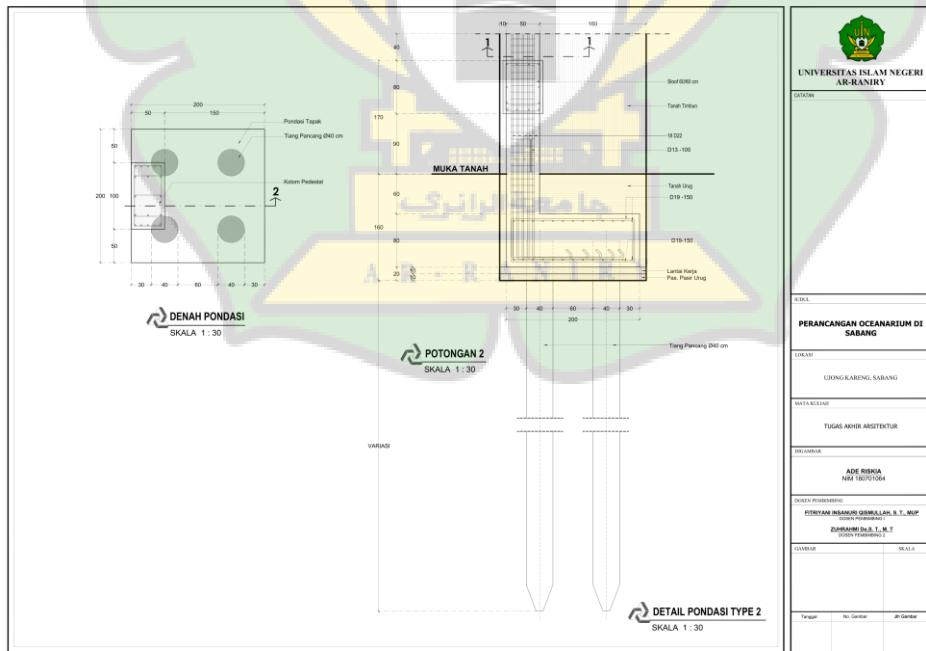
30 Denah Rencana Pondasi Tapak dan Tiang Pancang
